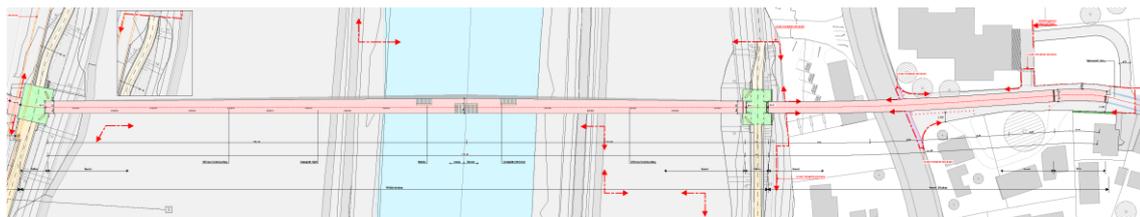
FVV Brücke / Passerelle L 203: Gesamtgrundriss
